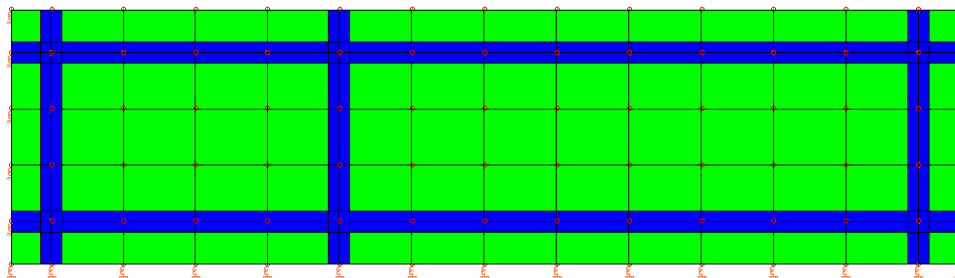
Vista in Pianta Platea e Travi di Fondazione
